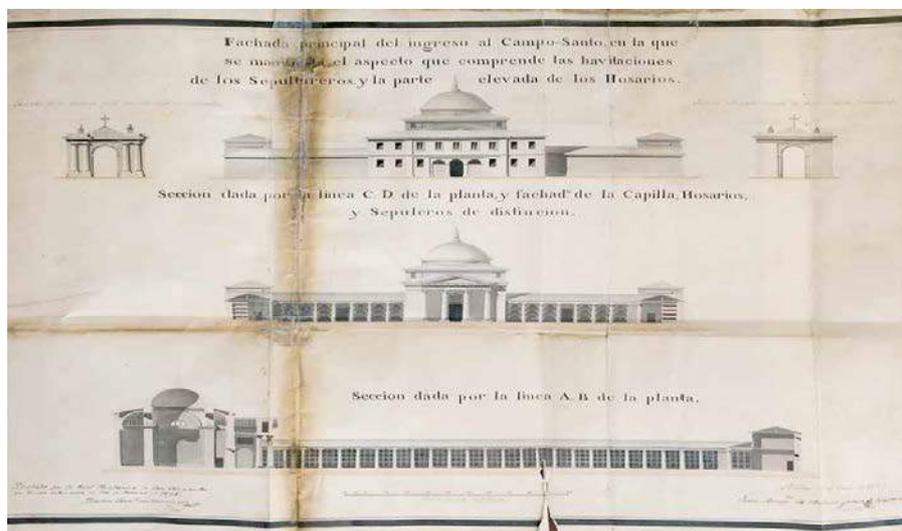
Plano del cementerio de Mallona, Juan Bautista Belauzaran. Recuperado de: José A. Barrio Loza
